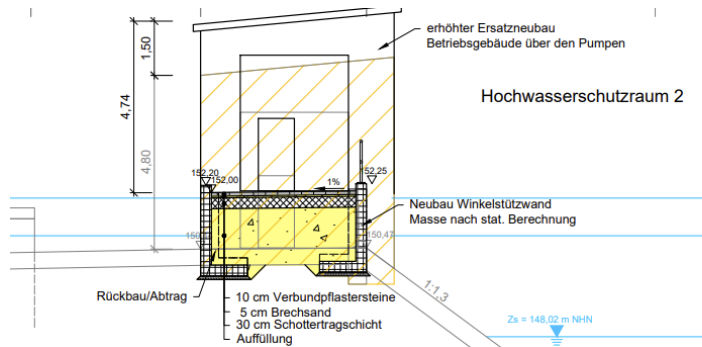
Zufahrtsrampe, Ausschnitt aus Plan-Nr. 2-5.2
